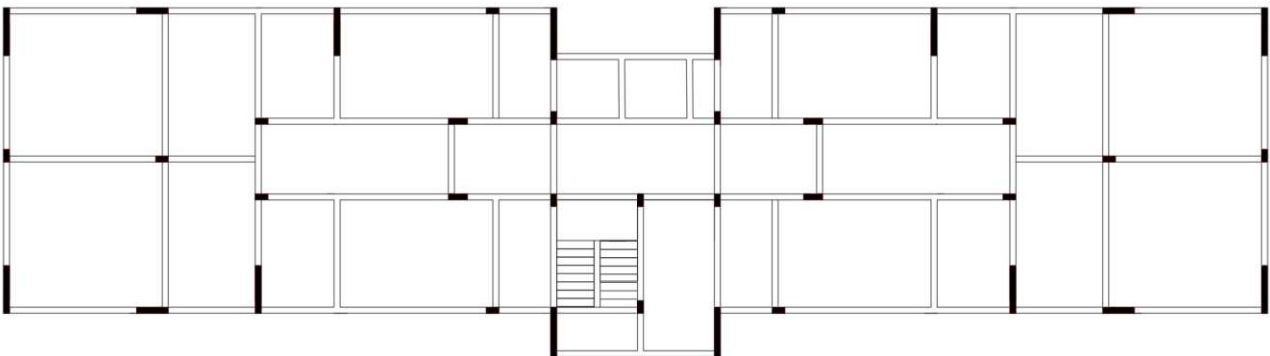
Modelo 02: Sistema constituído por pórticos com a adição de pilares-parede. (Fonte: Autor, 2023)
